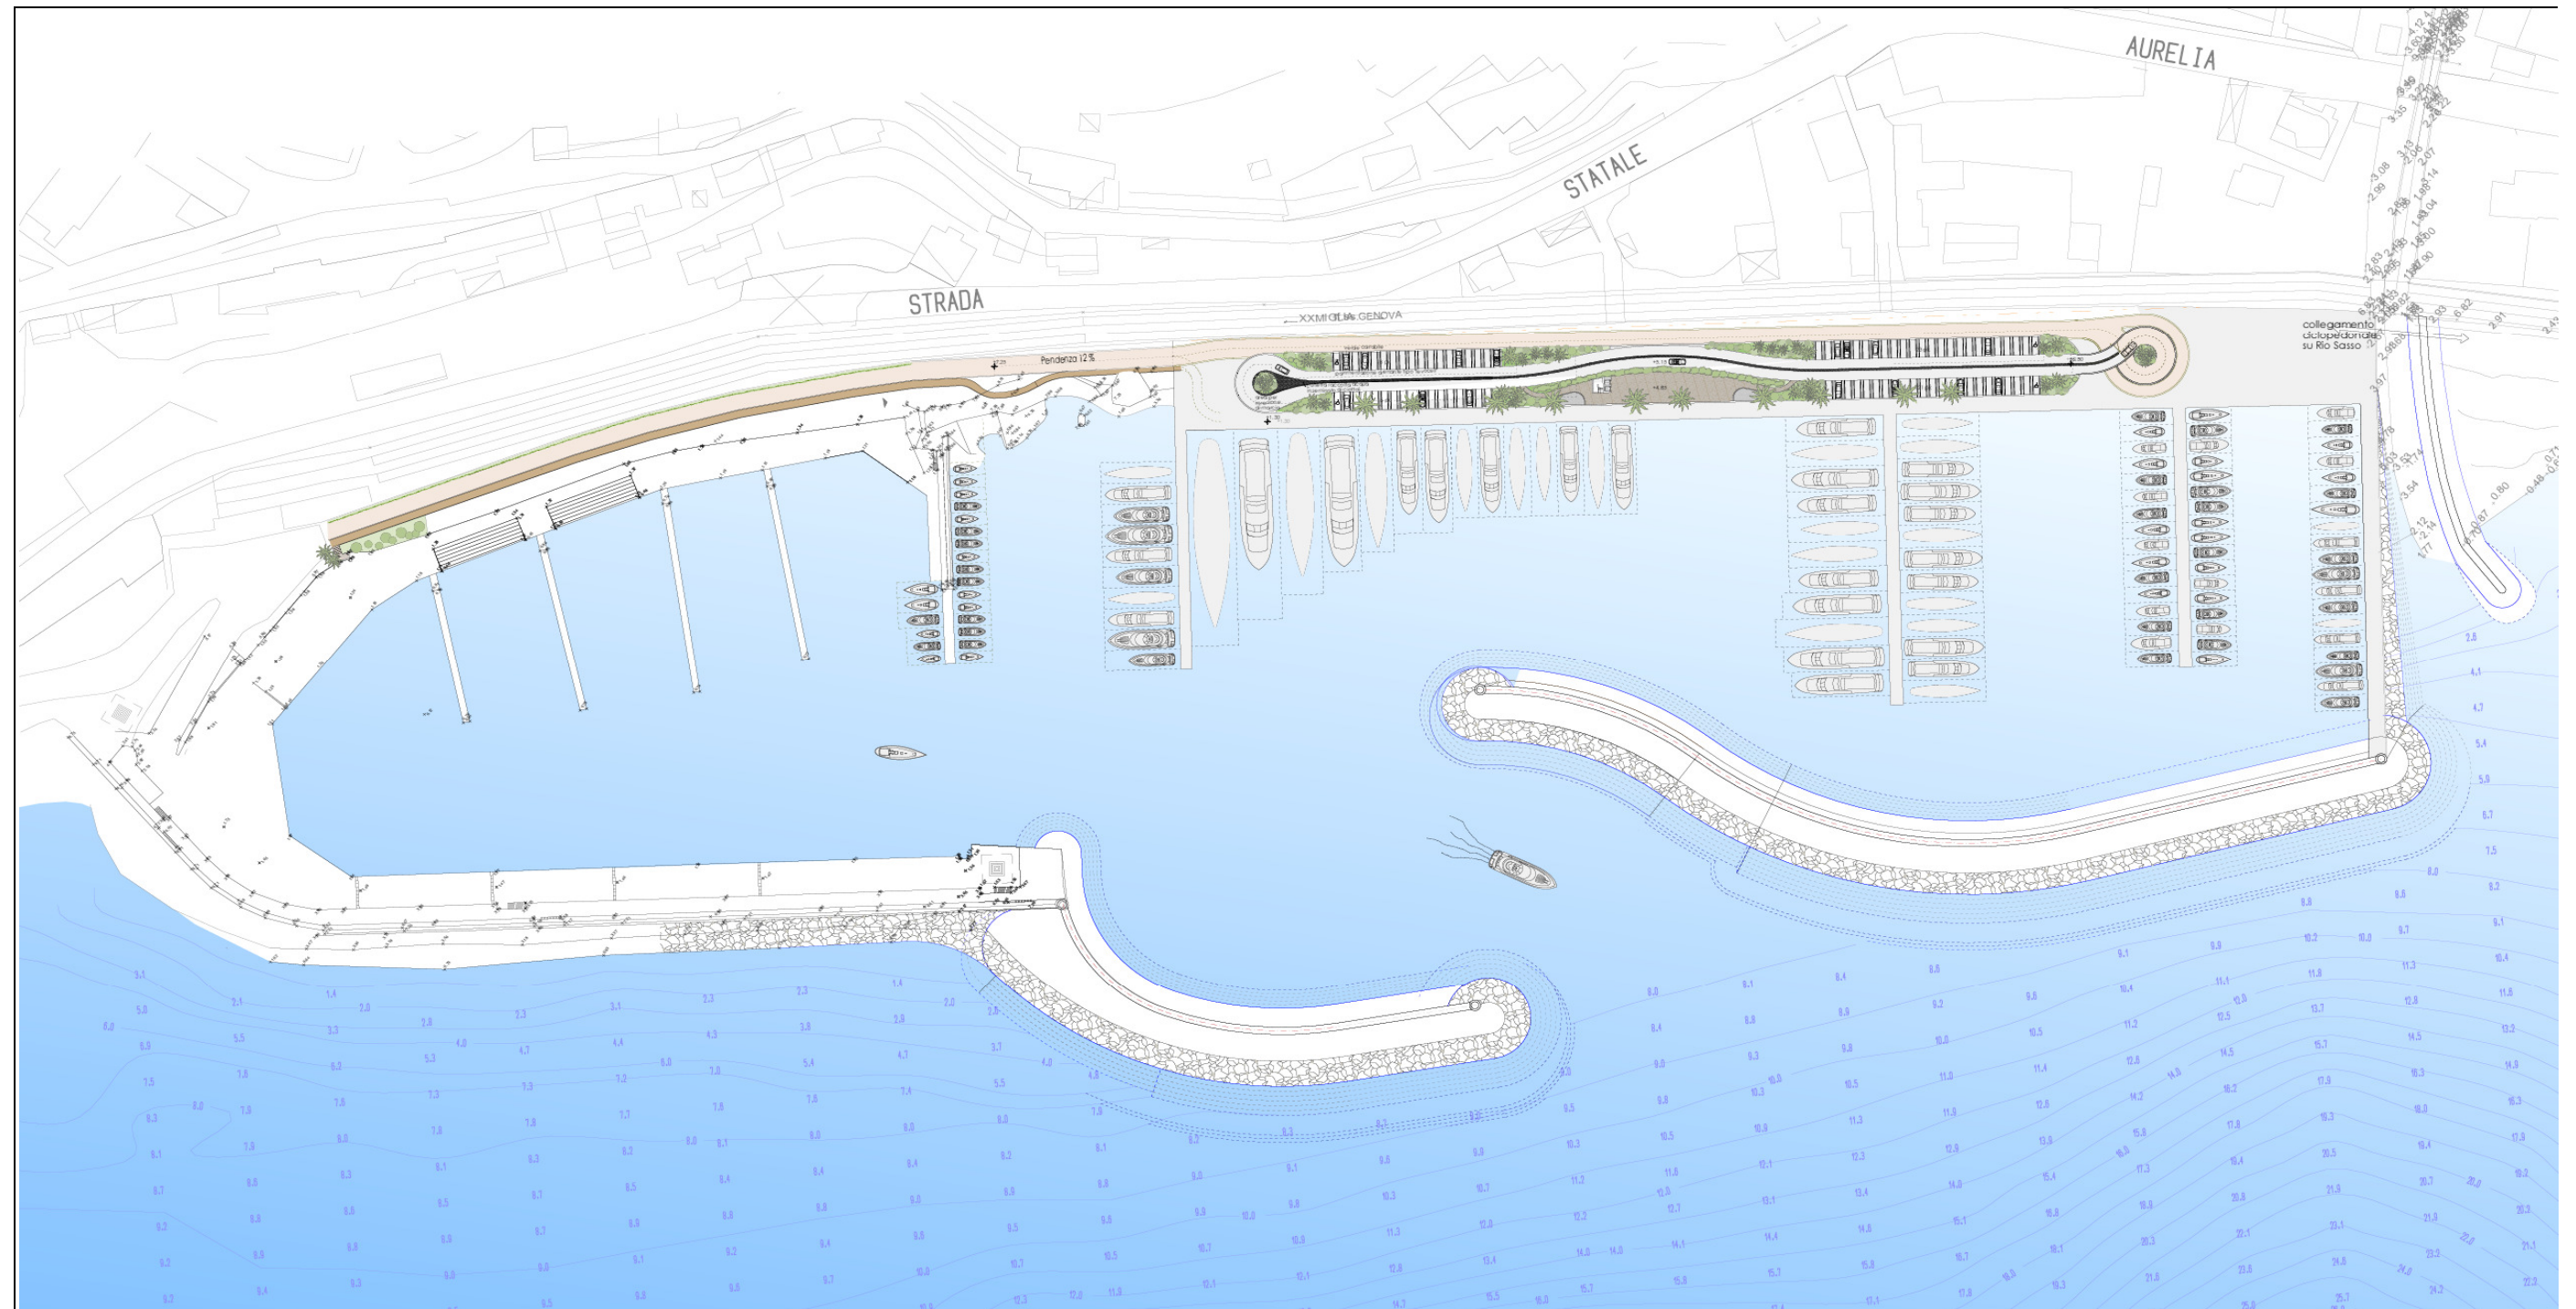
Planimetria area di intervento e layout del nuovo porto
